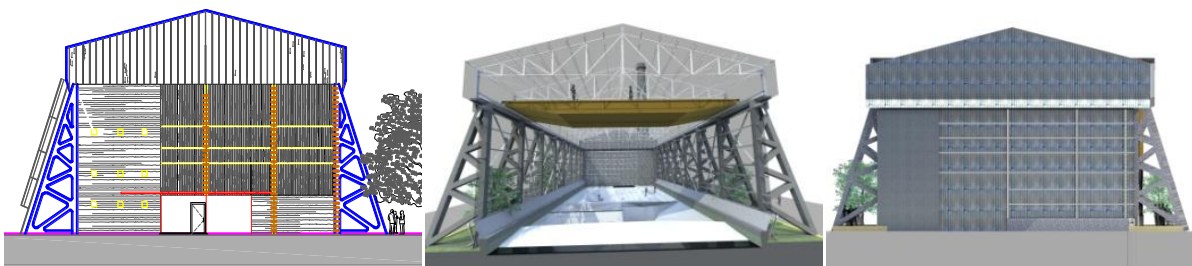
Levantamiento en CAD. Fig.62 y 63. Levantamiento estructural 3D y formal 3D)
